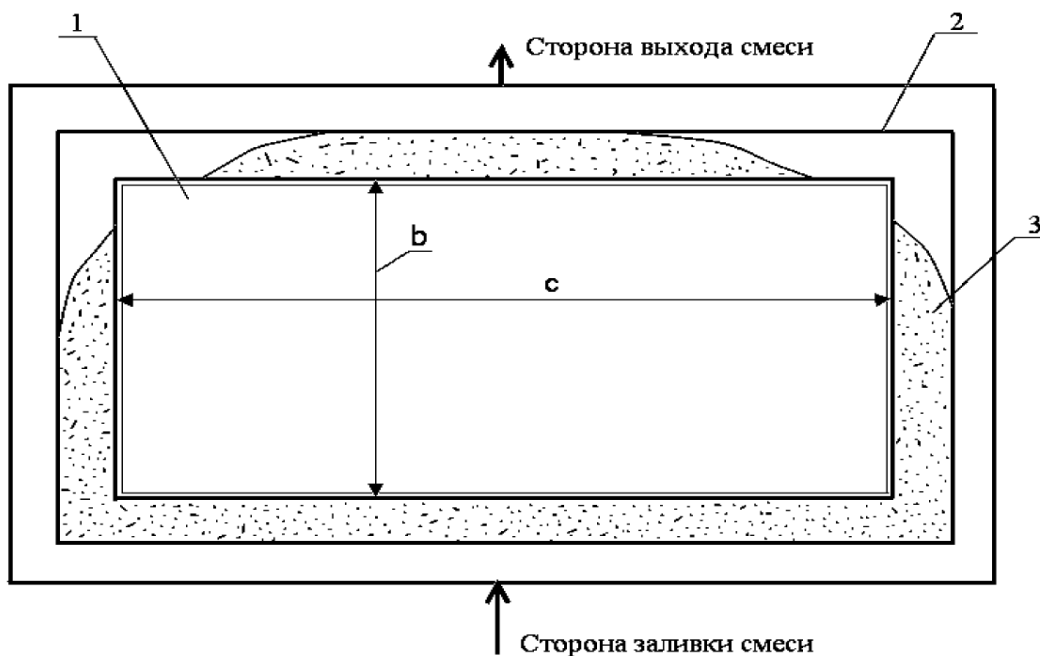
Схема устройства подливки под оборудование: 1 — оборудование; 2 — опалубка; 3 — смесь
